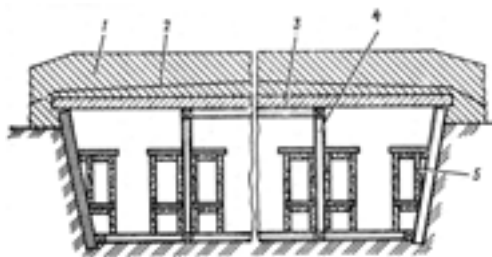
Трехпролетное БВУ с наклонными стенами из железобетонных плит распорной рамы из дерева: 1 – насыпной грунт; 2 – гидроизоляция; 3 – железобетонная плита; 4 – распорная рама; 5 – нары для укрываемых
